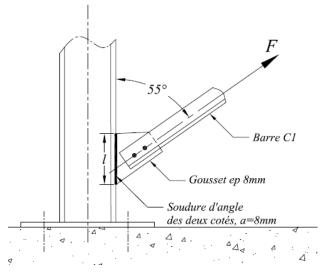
Détail A1 - Assemblage contreventement-poteau
